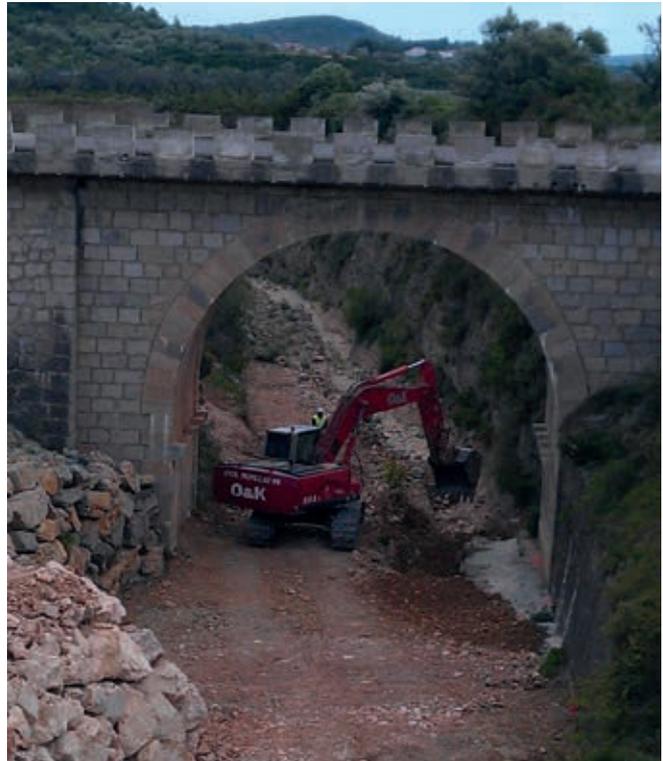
Trabajos para restitución de cauce por erosión en estribo S del puente de 1940. Se trata de una fase previa al escollero del lecho
